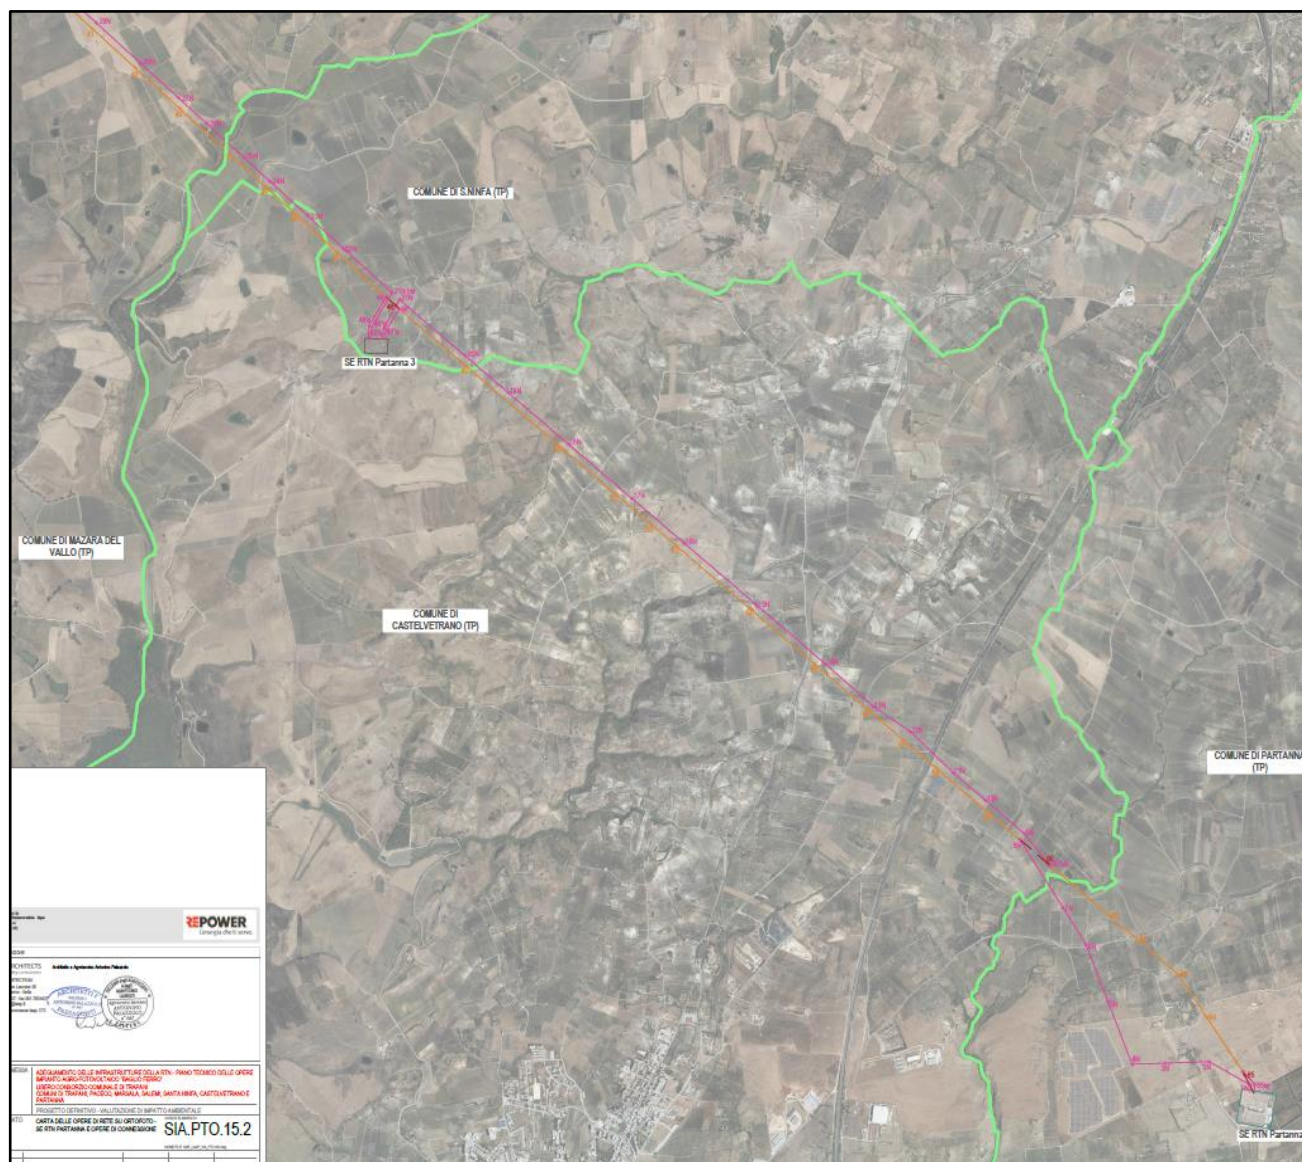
Inquadramento opere di rete su ortofoto Tav.B (Scala 1:10000)
